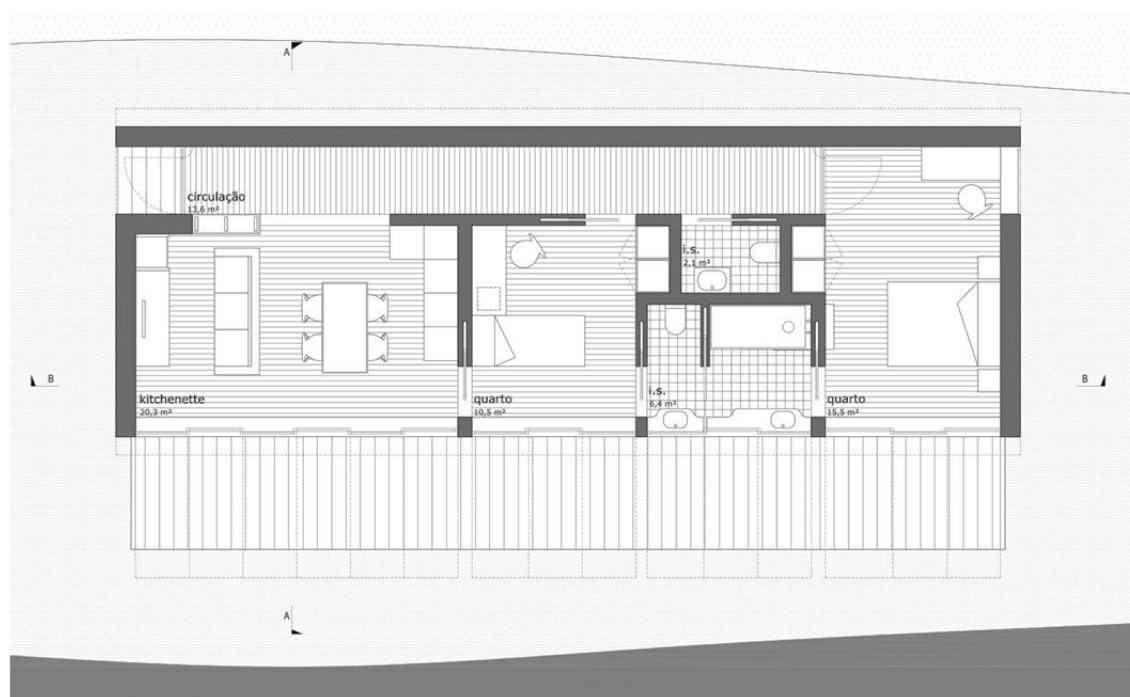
Planta do módulo T2 em que se verifica a orientação dos espaços para os planos de água e fachada cega para os acessos da ilha da Murraceira. *Proposta de intervenção.
